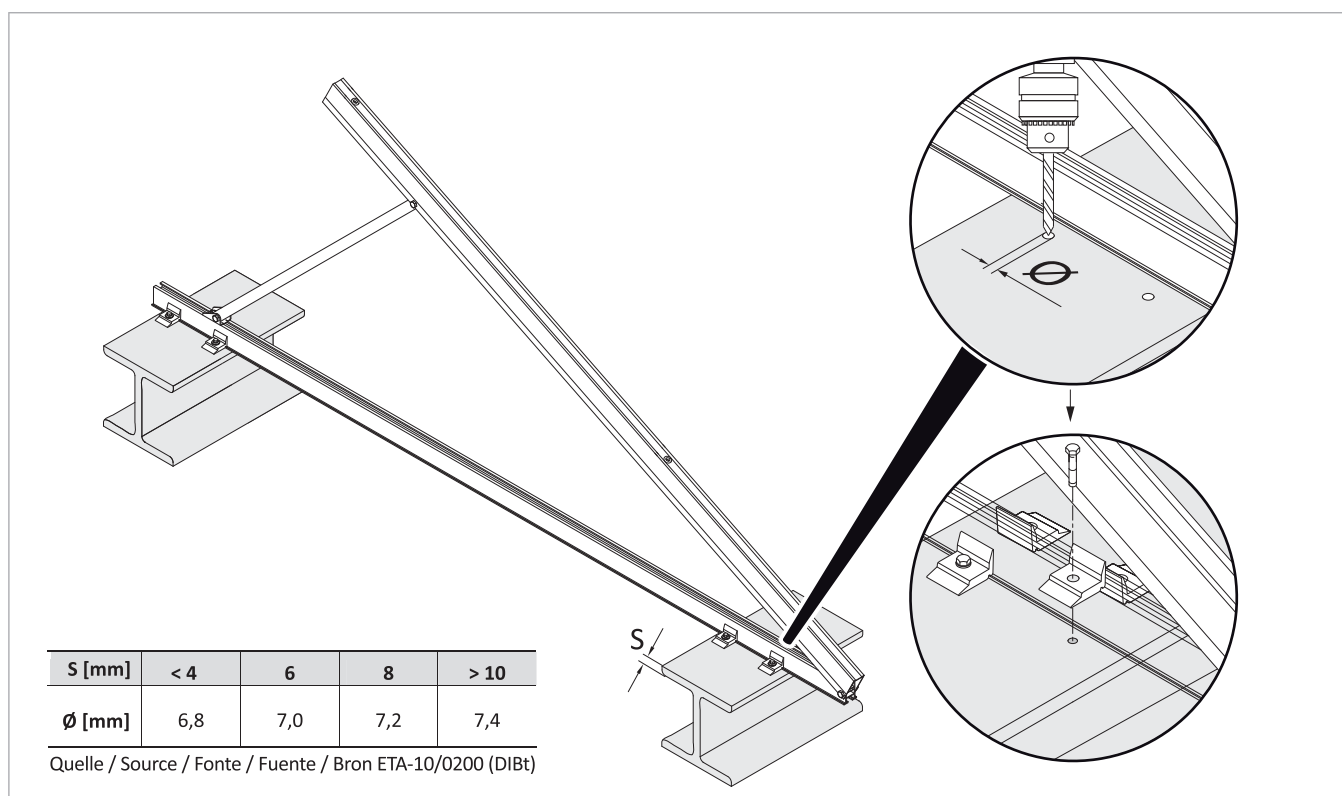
montage du montant pour toit plat sur poutres en acier avec vis autotaraudeuses (kit de fixations sur toit plat MUK)
